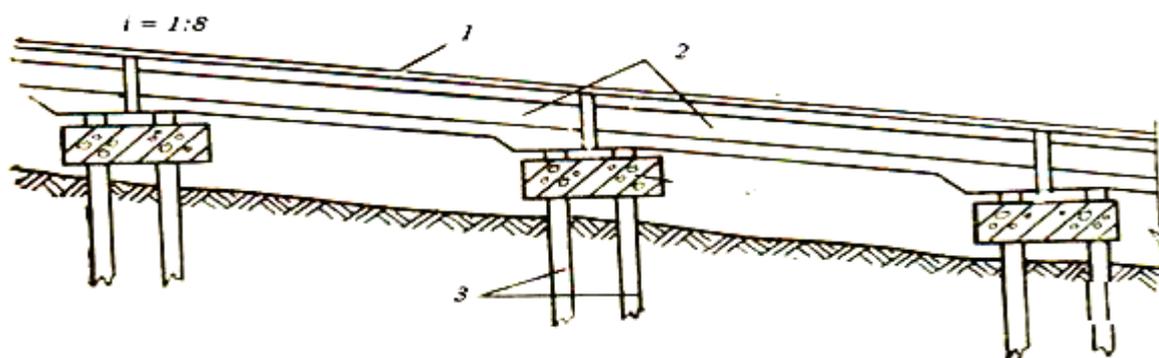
Разрезные балки на опорах в виде кустов свай (1 – рельс, 2 – железобетонные балки, 3 – сваи)
